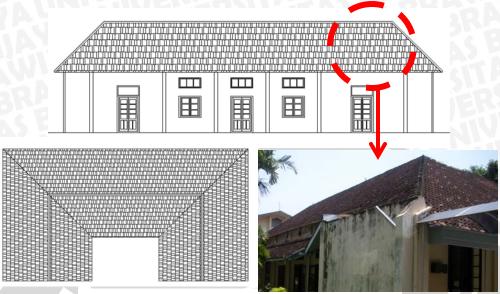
Tampak dan atap bangunan Pengadaan
